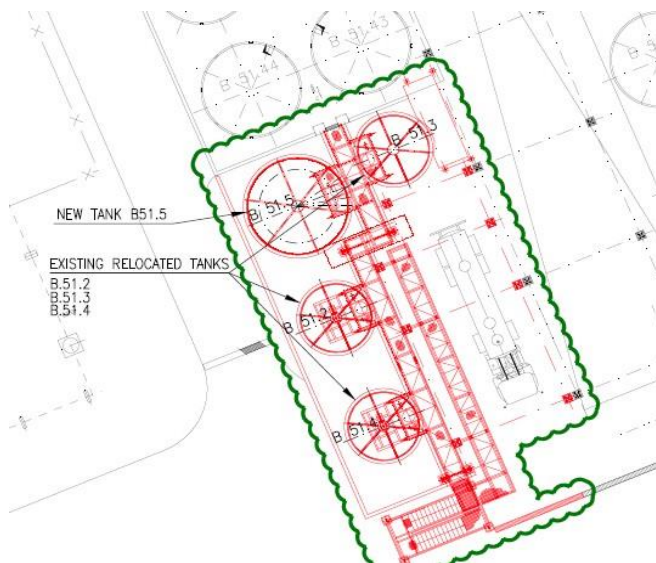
Planimetria nuova collocazione serbatoi B51.2÷B51.4
